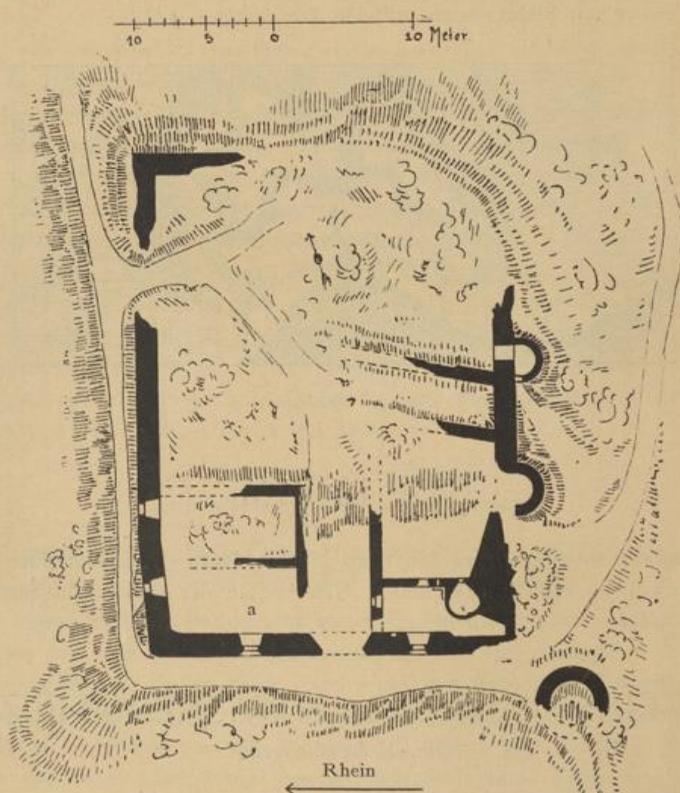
Weisswasserstelz. Grundriss der Burg. I.
